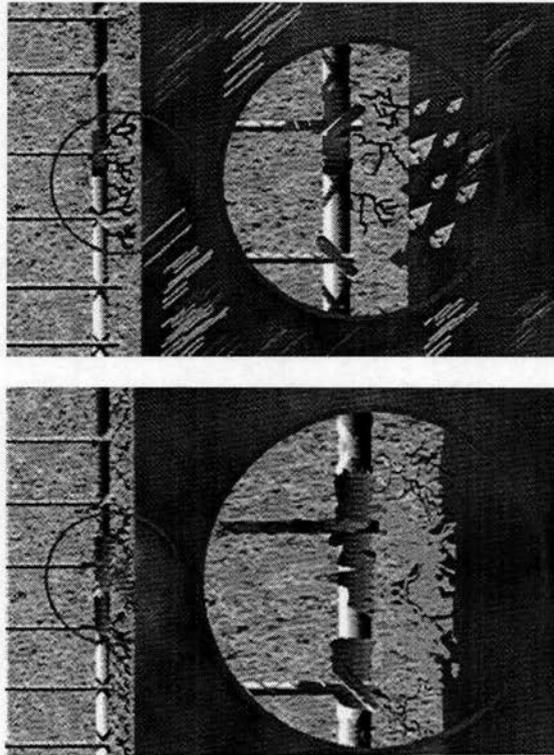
Ácido Carbónico penetrando en el concreto y facilitando la corrosión.
